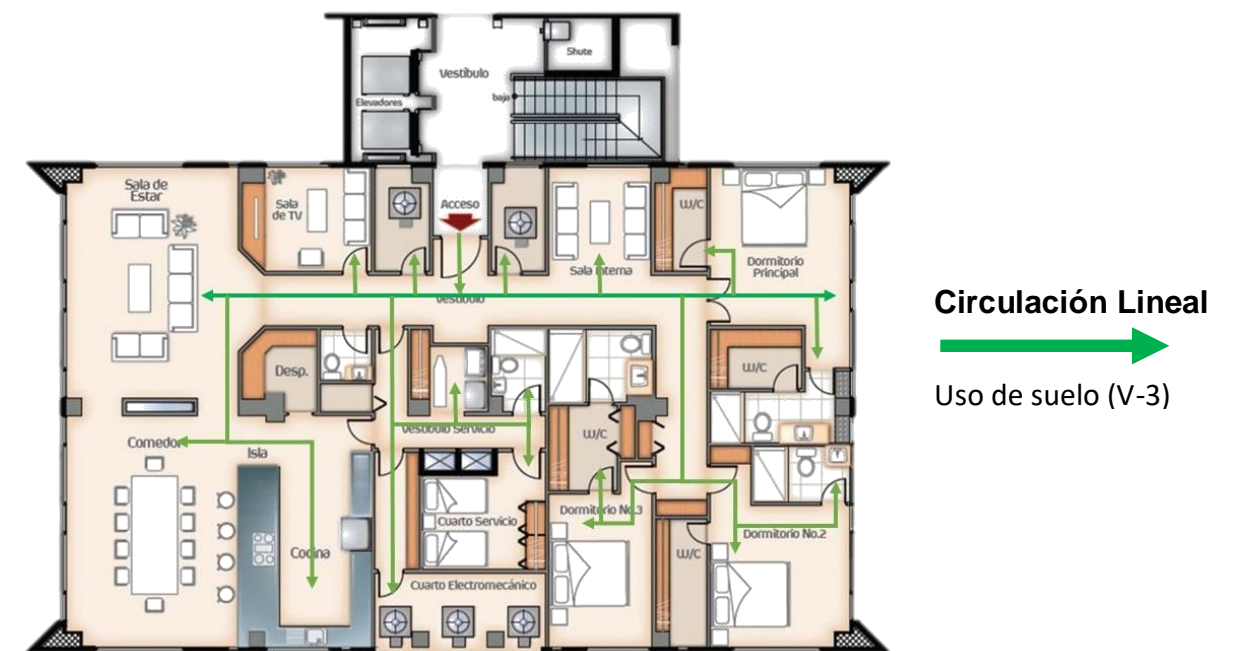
Planta Arquitectónica Apartamento Piso Entero y circulación
